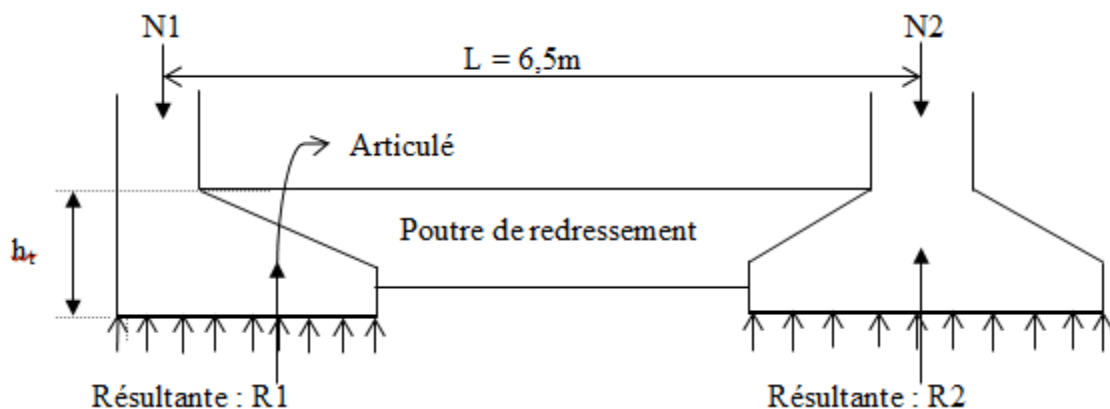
Fonctionnement d'une semelle excentrée avec la poutre de redressement.
